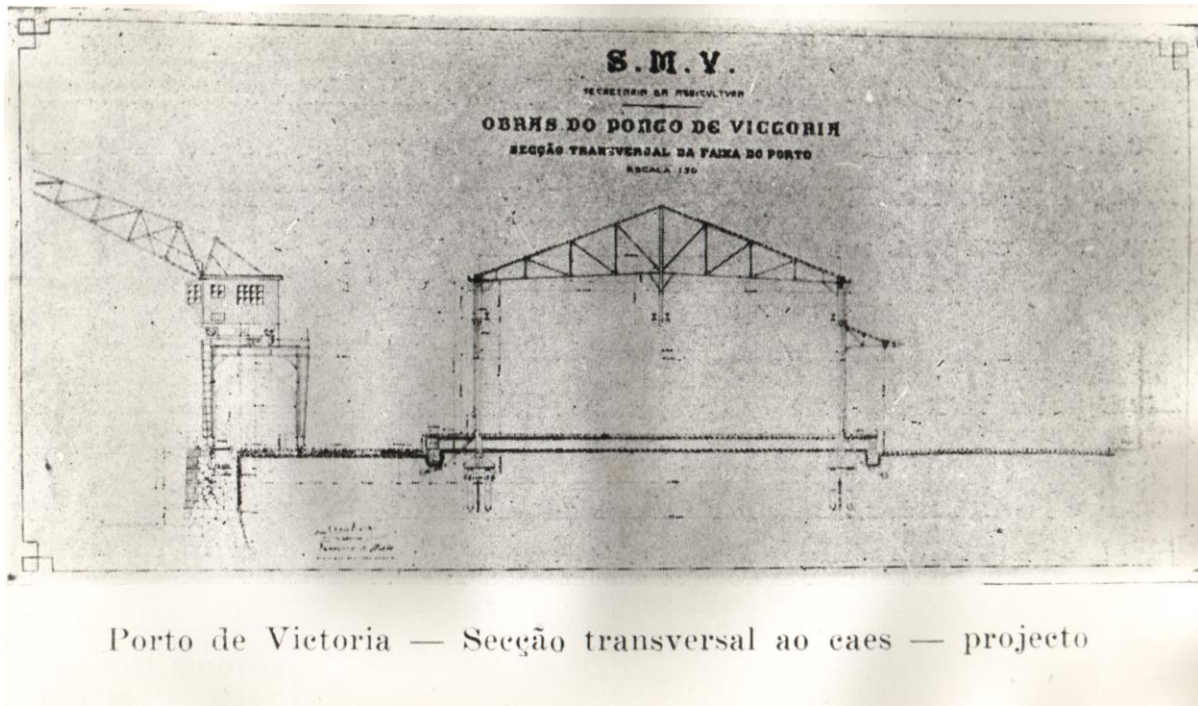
Porto de Vitória - seção transversal ao cais - projeto.
